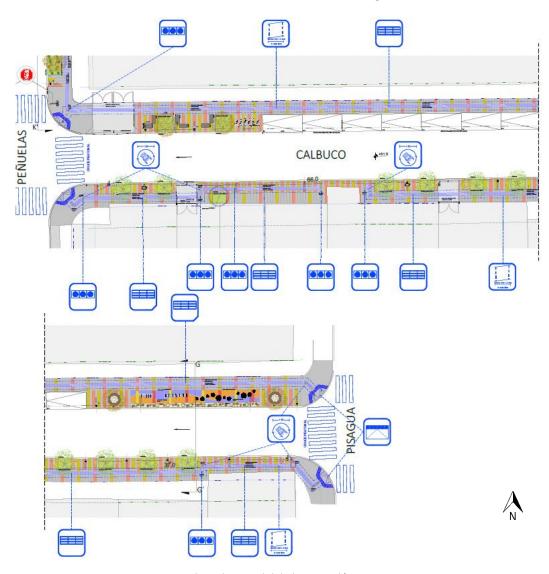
Plano de accesibilidad universal/ Guixe Arquitectos Spa.
